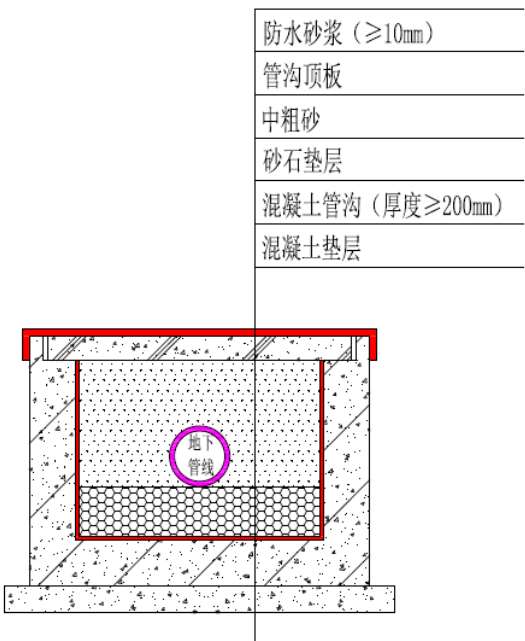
抗渗钢筋混凝土管沟防渗结构示意图
